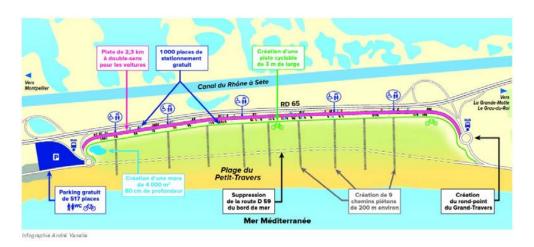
plan d'aménagement de Petit Travers (source : la Gazette de Montpellier)
